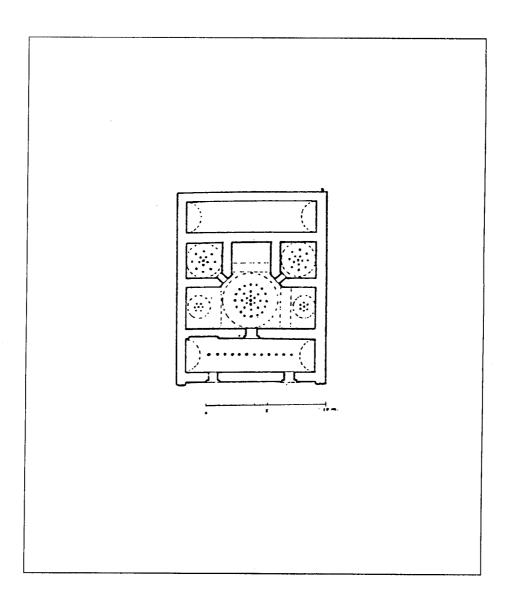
مسقط أفقي لحمام نيش (عن : ايفردى).
